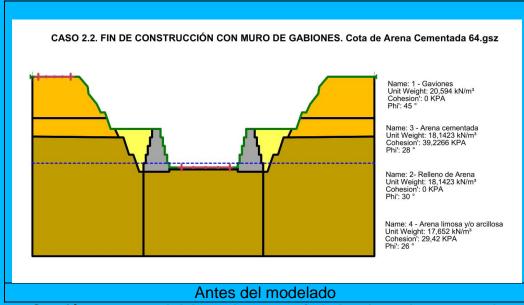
Sección transversal del canal con propiedades de suelos y muro de gaviones construido.
